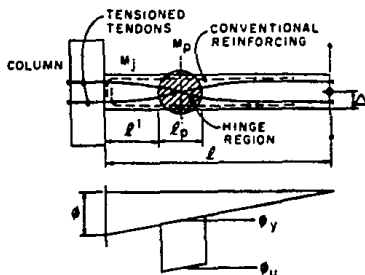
Conexión trabe-columna con articulación plástica fuera de la unión.
